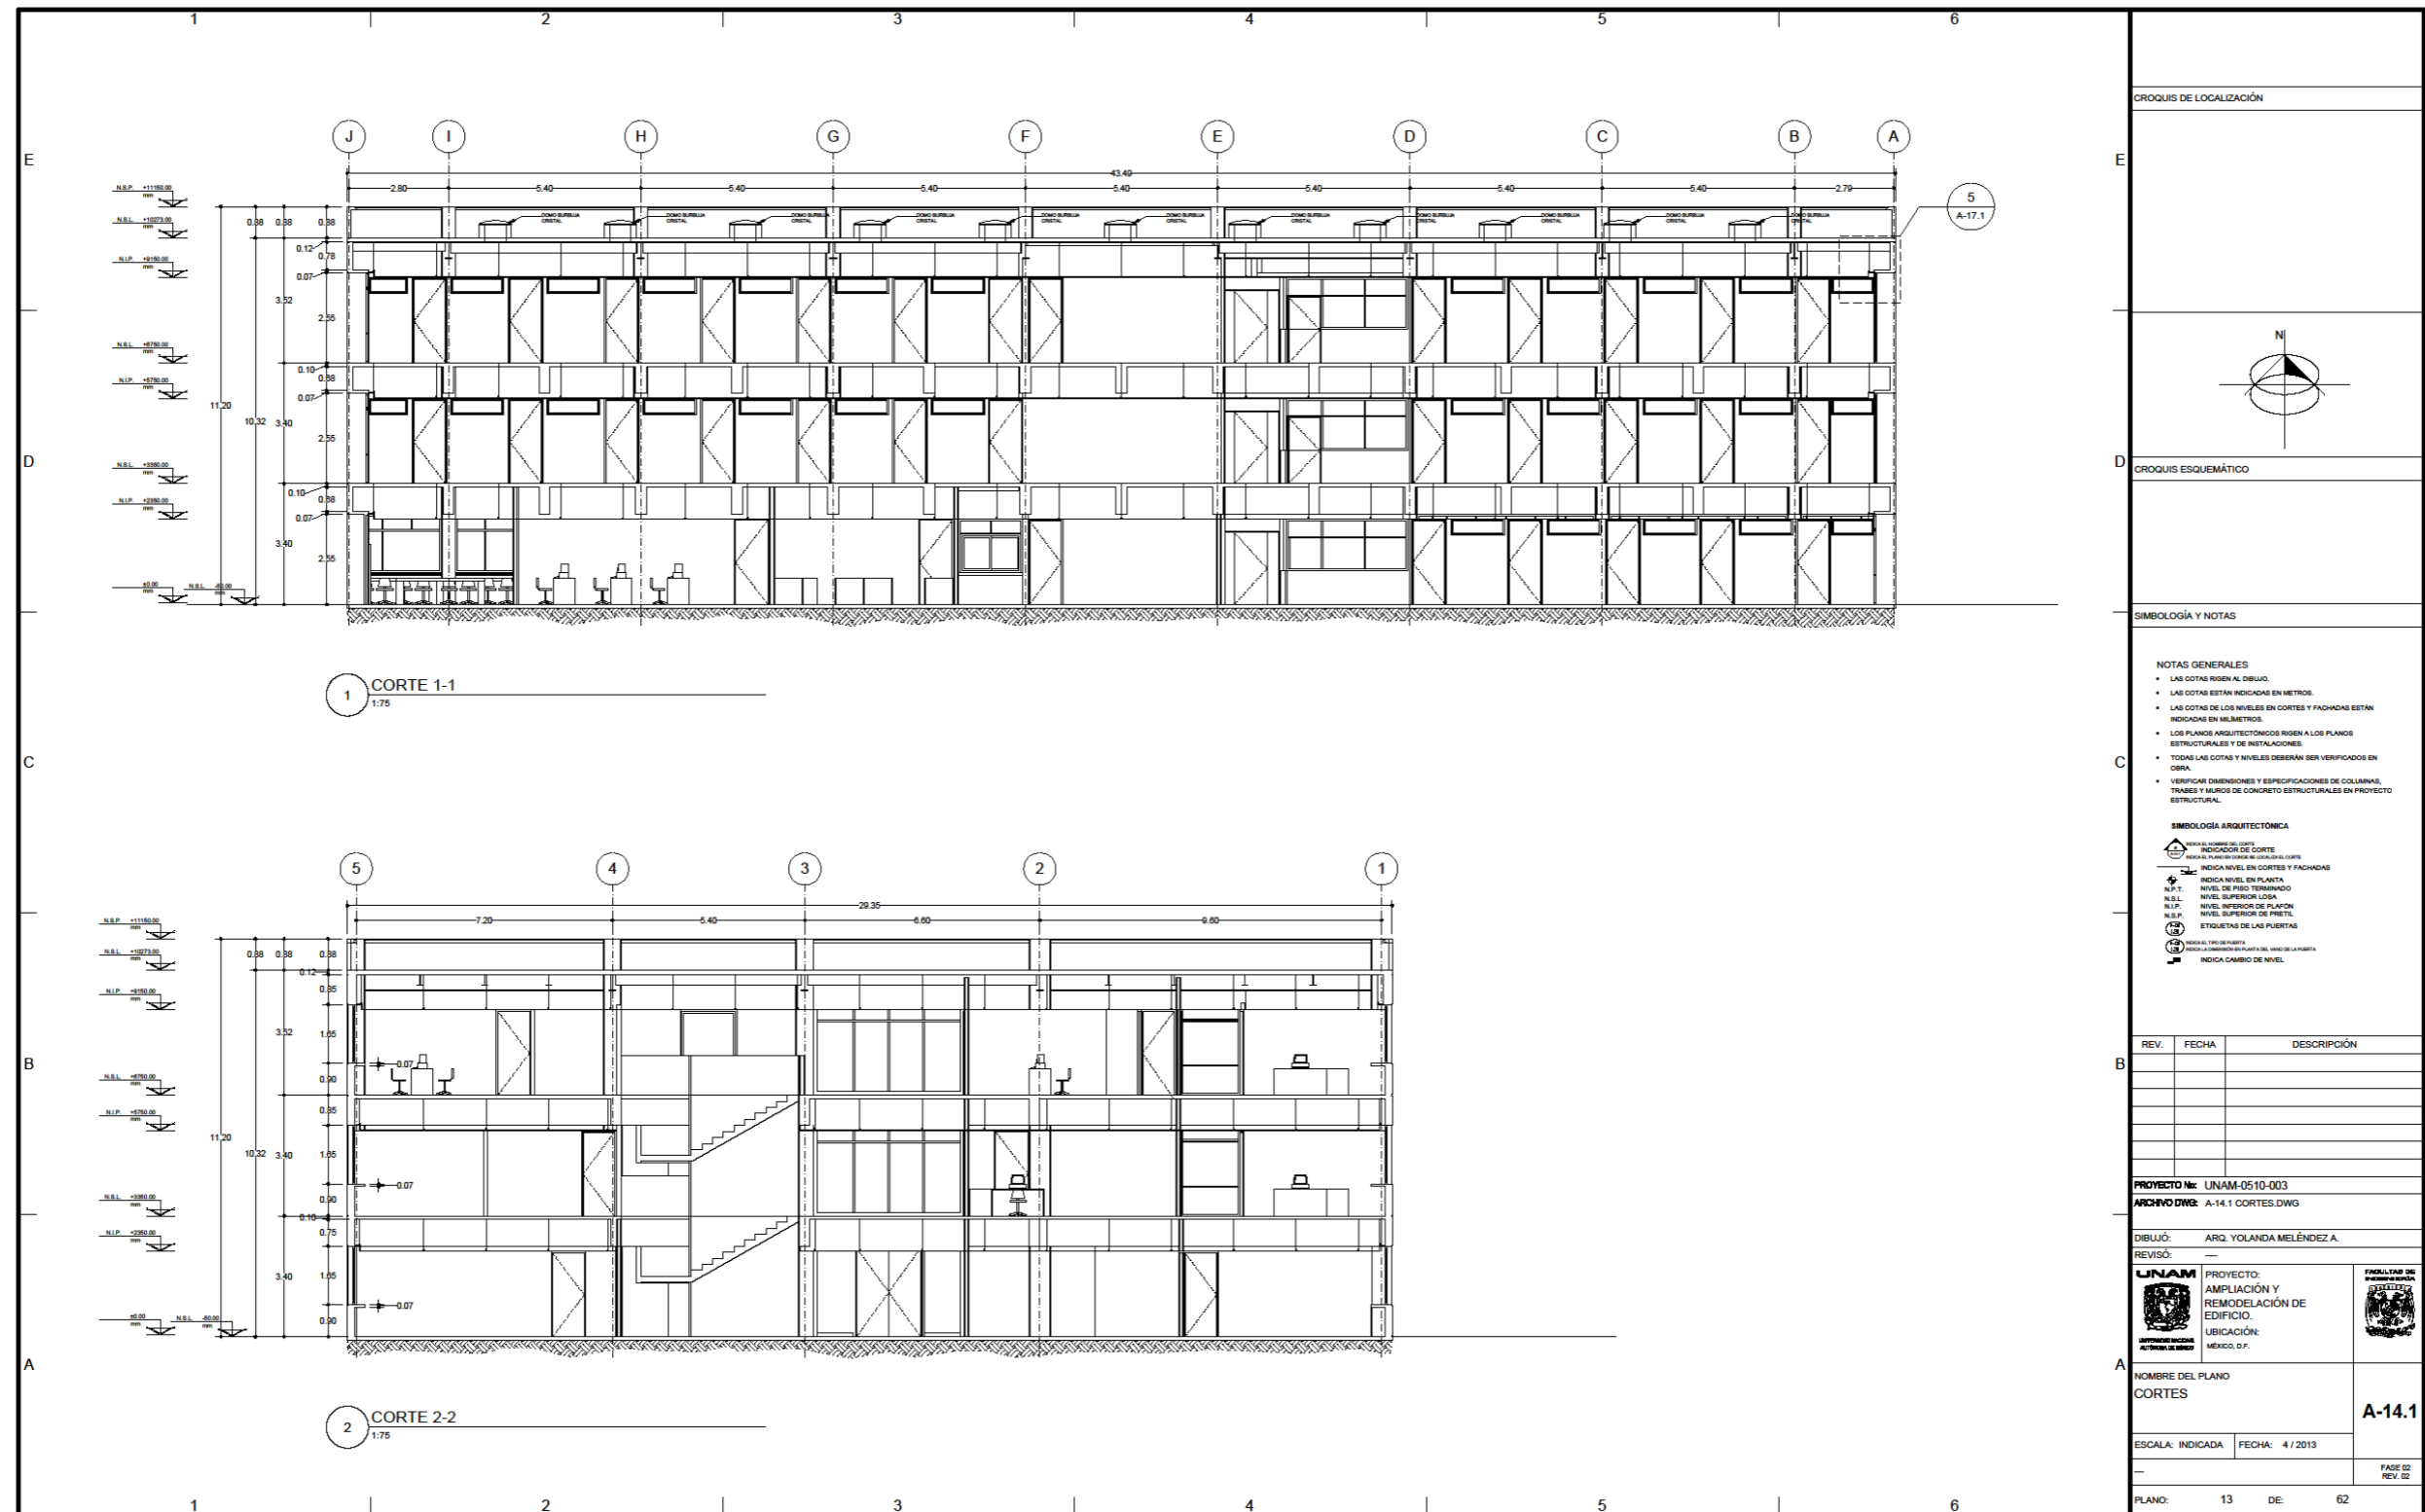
Plano A-14.1 Arquitectónico Cortes
